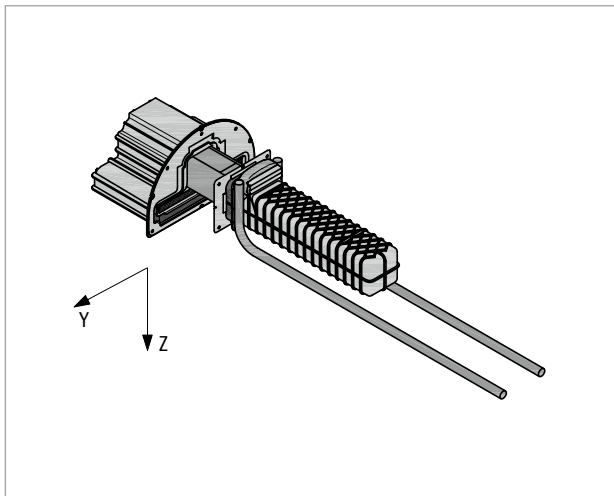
Schöck Tronsole® Typ P: 3D-Ansicht mit Achsbezeichnung
